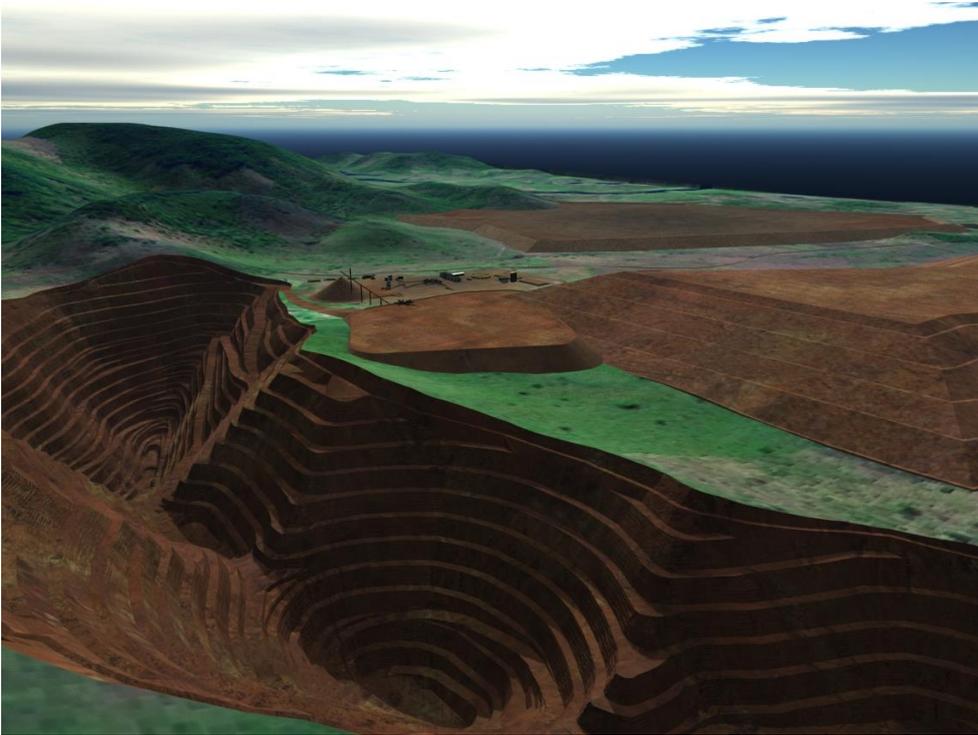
Montagem Esquemática sobre Fotografia da Cava, Pilha de Estéril Leste, à Direita no Centro, e Bacia de Rejeitos, ao Fundo. Na Parte Central, entre a Cava e a Pilha de Estéril, Planta de Beneficiamento e Pilha de Solo Fértil para Recuperações Finais
